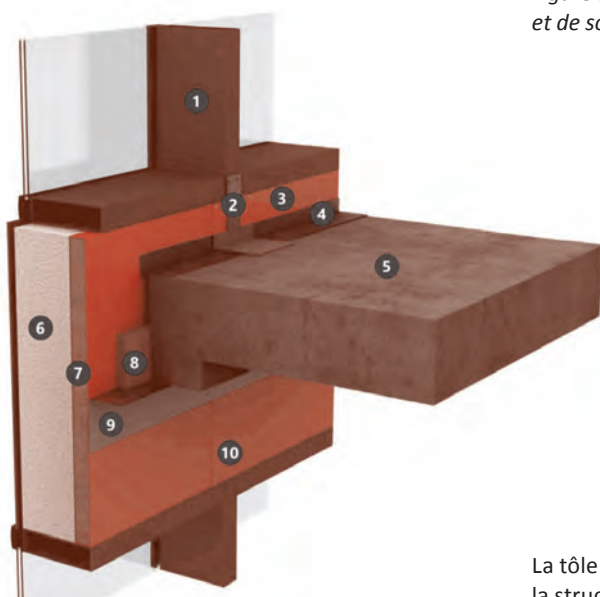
Exemple type de l'élément de façade pare-flamme E 60 et de son raccord EI 60 au plancher de compartimentage. (source : CSTC)
